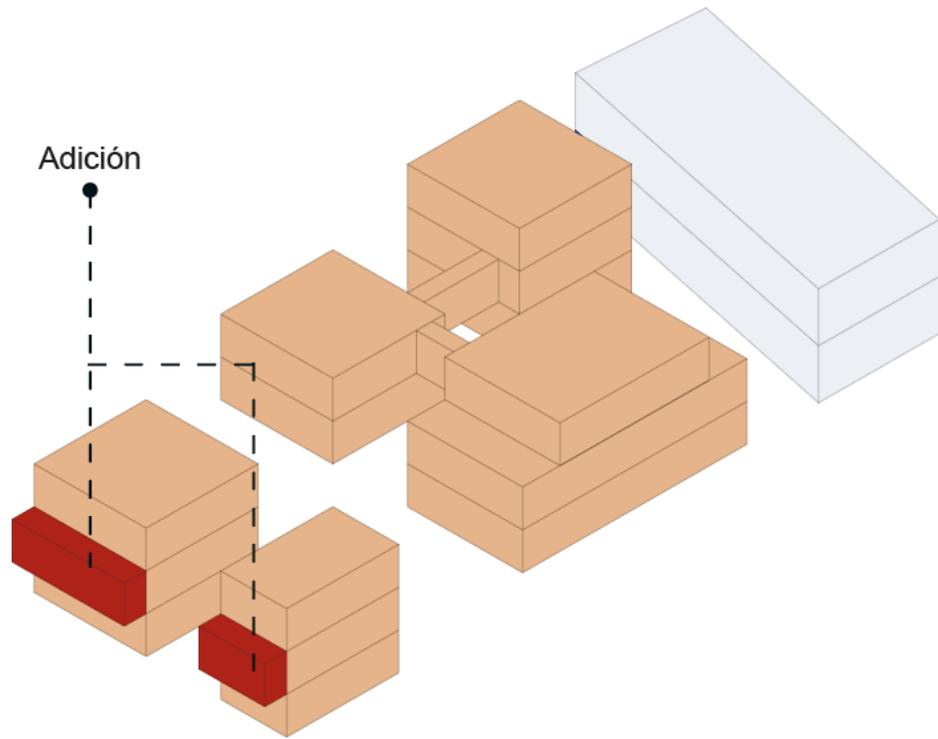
Adición de elementos en los bloques hacia la Bajada del Padrón
